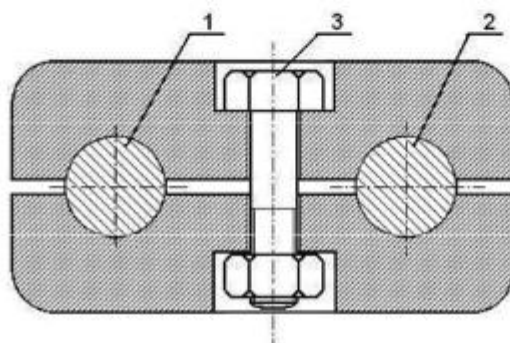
Connessione di un conduttore a sezione circolare ad un ferro d'armatura
